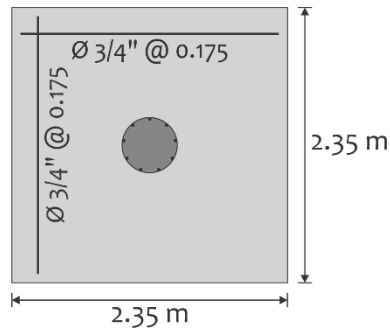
Detallado Final en la Zapata Aislada Más Crítica.
